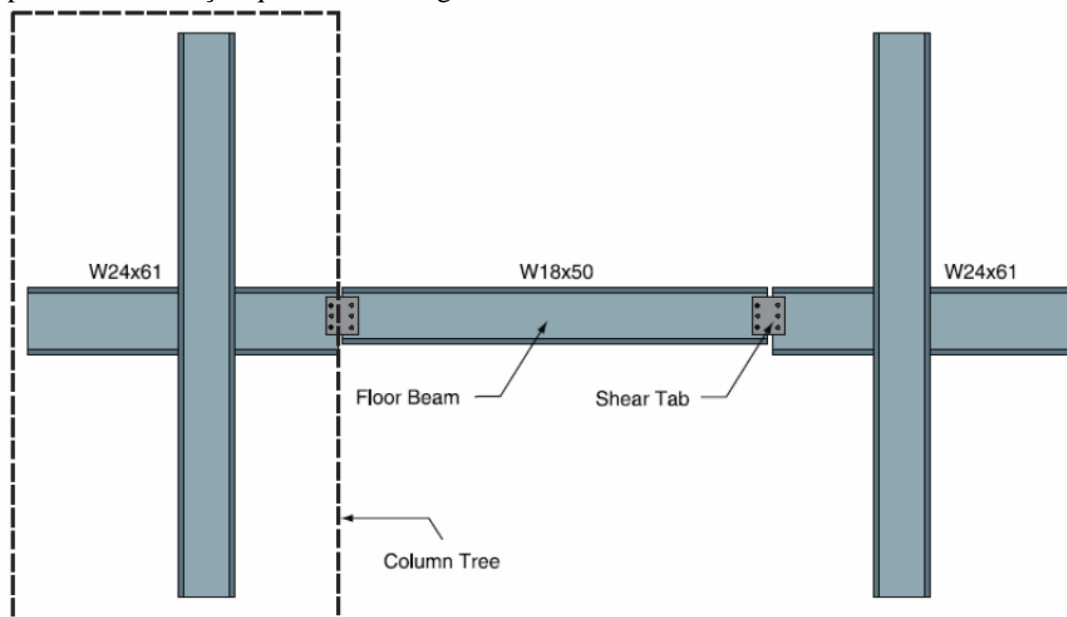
Desenho esquemático das ligações com vigas Gerber utilizadas nos pisos 5 a 8 do WTC 5. [48]
